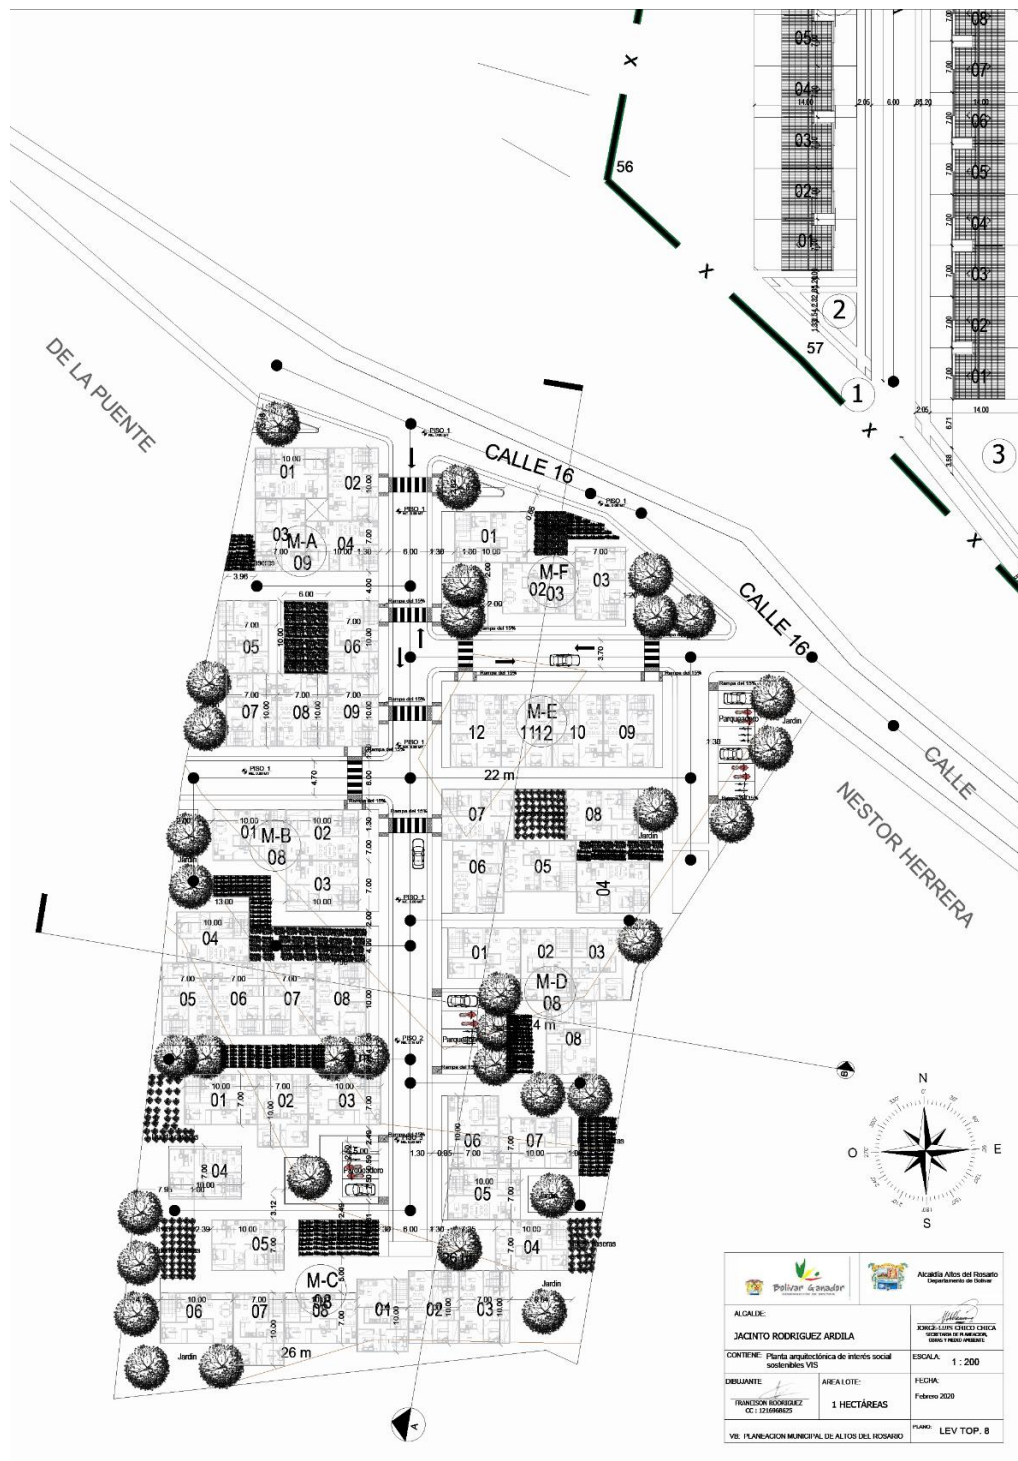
Planta arquitectónica del loteo de vivienda de interés social sostenible fuente autor
